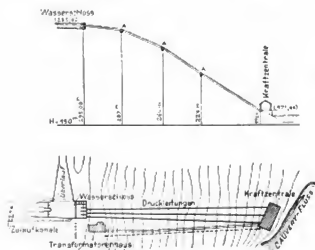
Längensprofil und Lageplan der Druckleitung.
